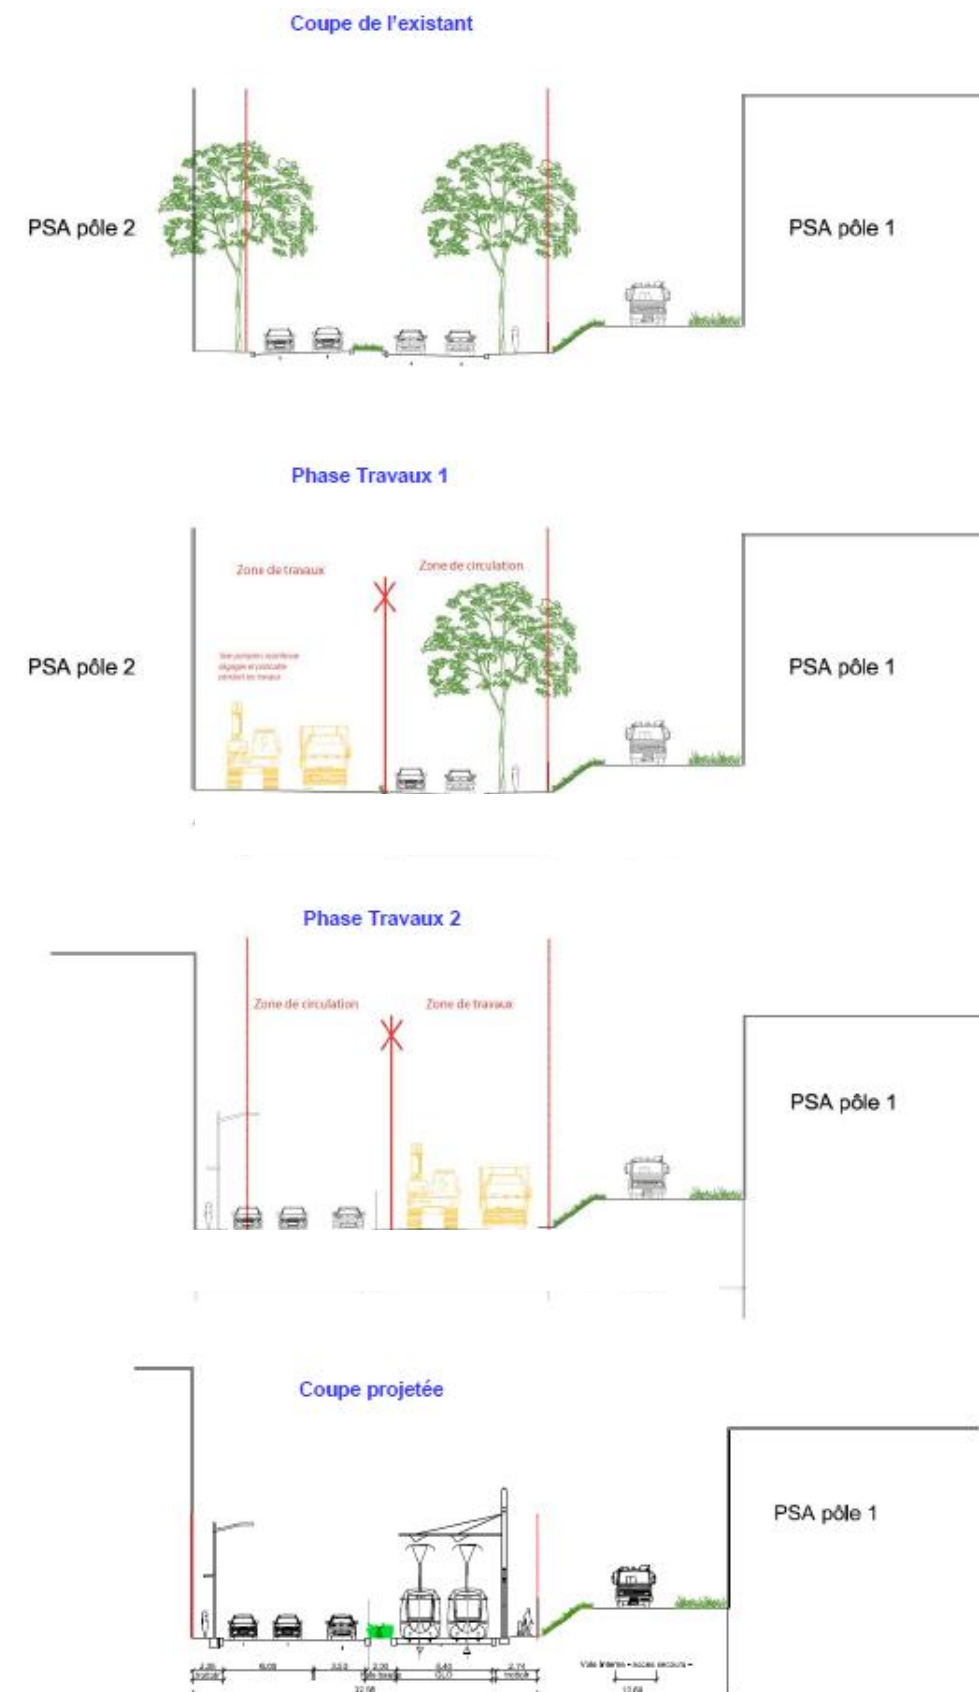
Principe de phasage sur le boulevard de l'Europe (section existante)
